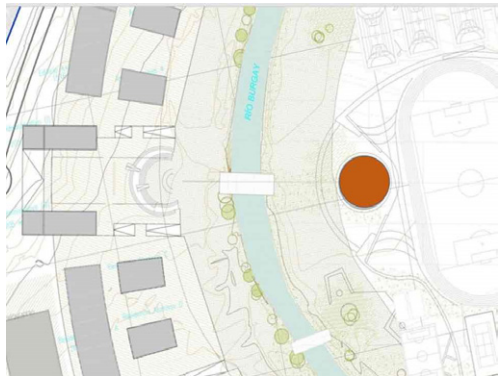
/ Imagen del Plan Masa- Planta de localización del CRAI
